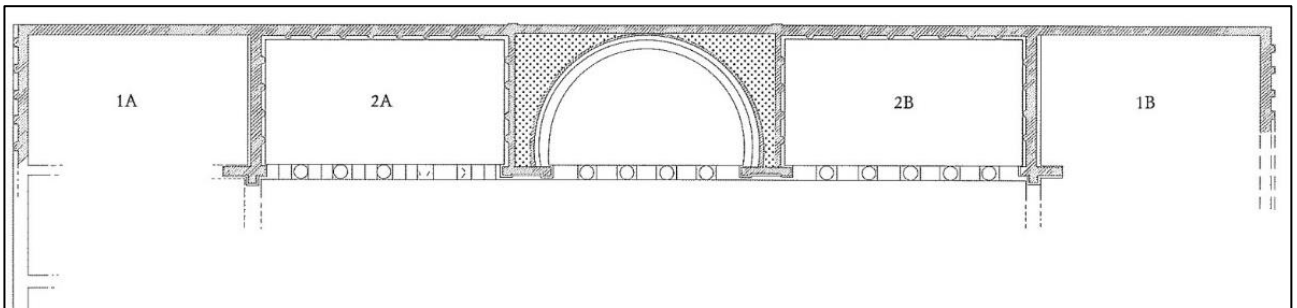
Pianta ricostruttiva delle strutture del Ginnasio di Stratonicea (da Mert 2008)
